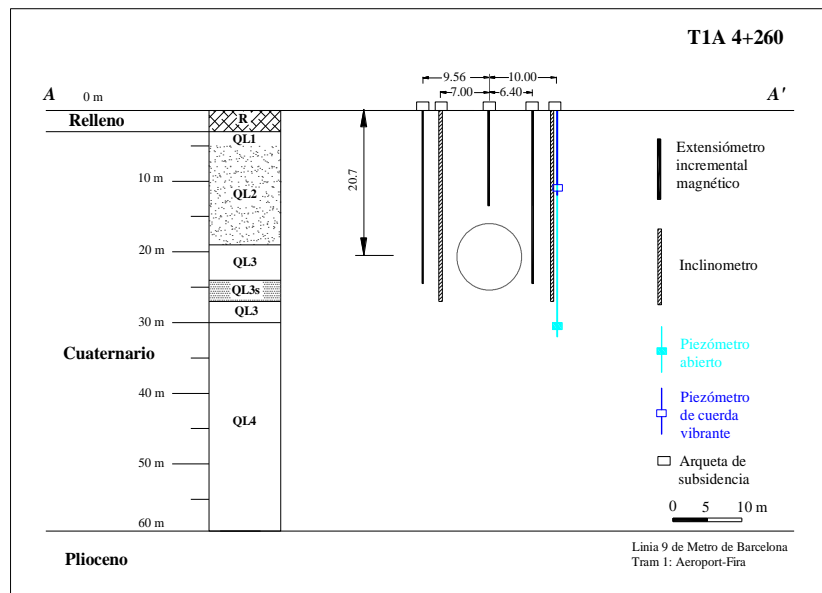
34. Perfil de la instrumentación instalada en la sección de control T1A PK 4+240
